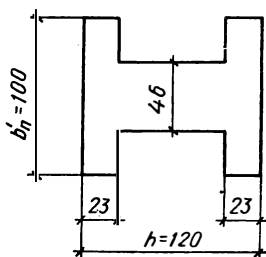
Сечение для расчета продольной арматуры подколонника.
